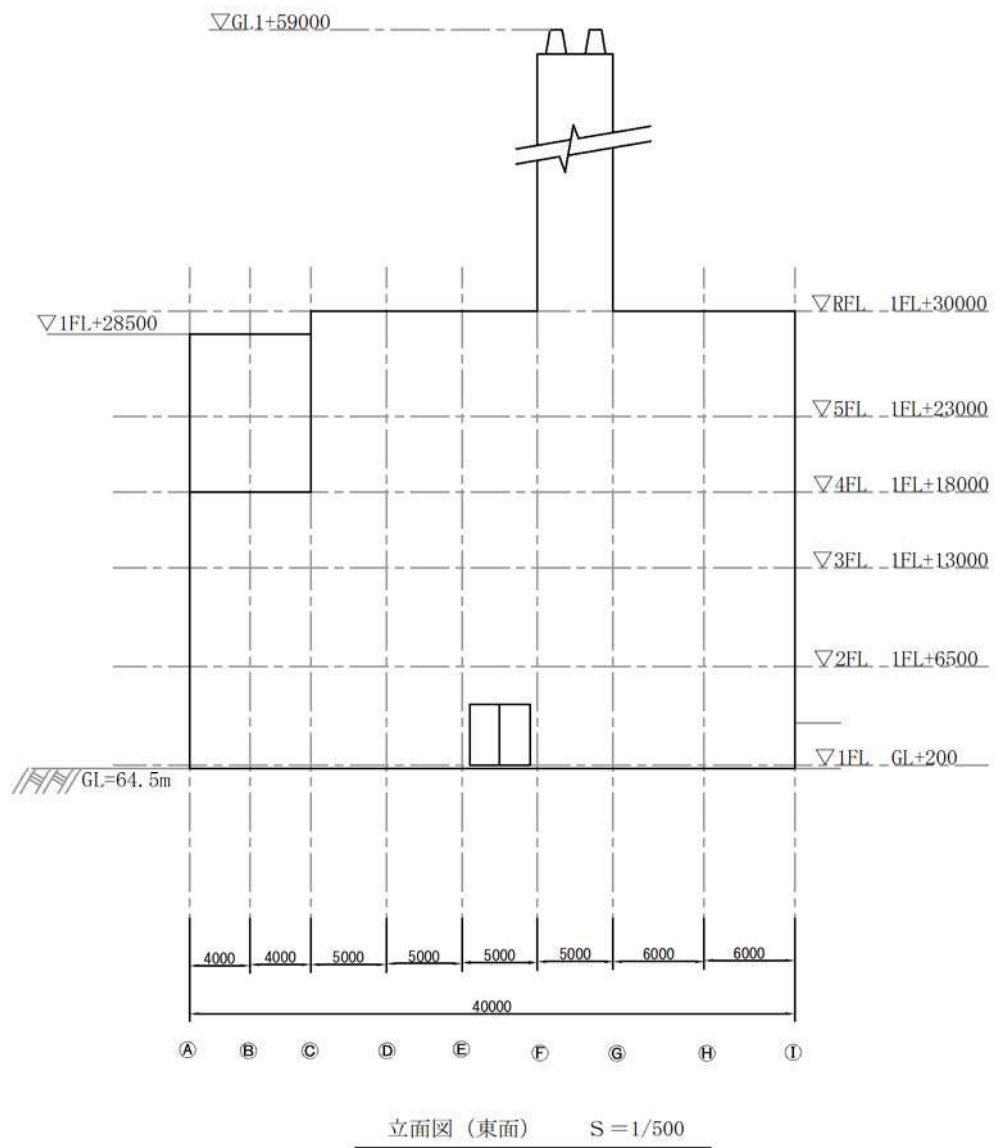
新可燃ごみ処理施設立面図 (案) (東面)
